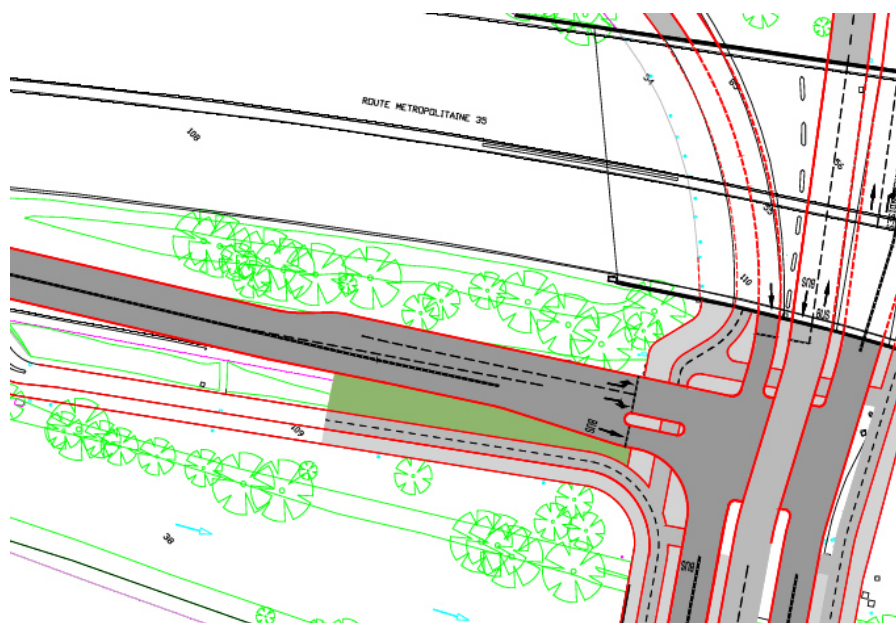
VUE EN PLAN SORTIE M35 « LES HALLES »
